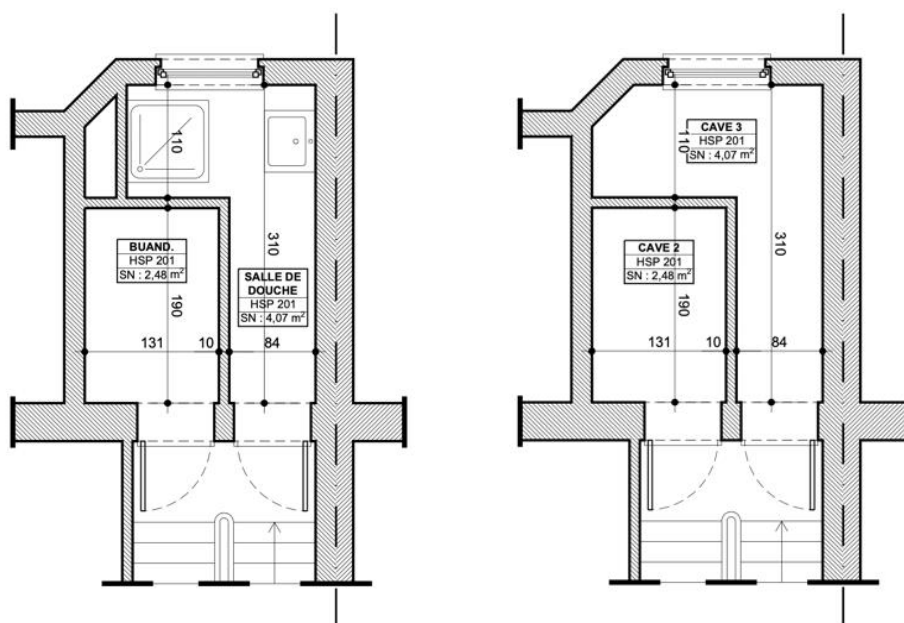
Plans des situations de droit (à gauche) et de fait (à droite) de l'aménagement de l'entresol, convertie de salle d'eau en caves privatives pour les logements 2 et 3.
